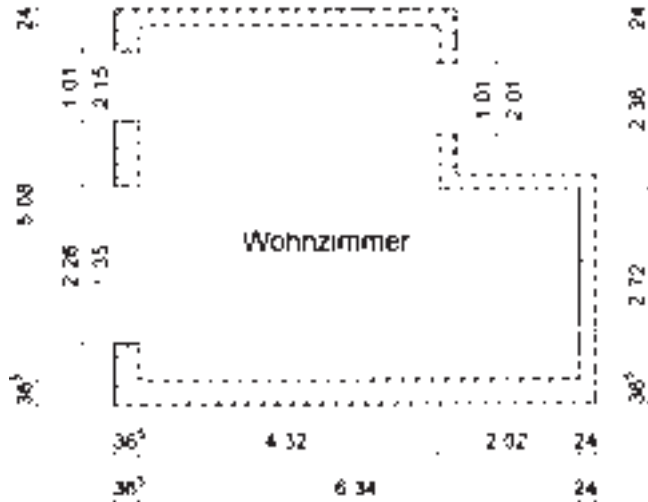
Wohnzimmer mit Fertigmaßen, Raumhöhe 2,40 m
